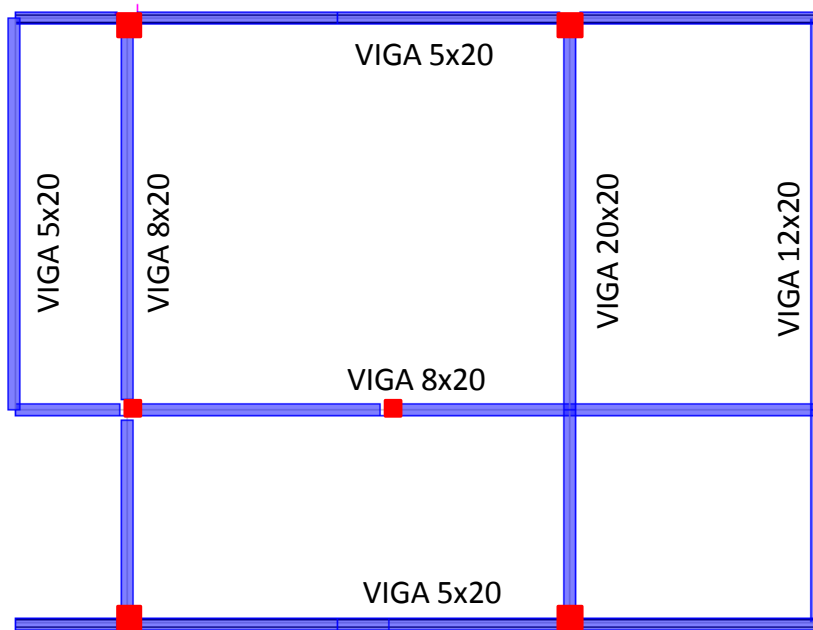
Definición secciones de vigas planta de piso 2 de vivienda de guadua laminada
